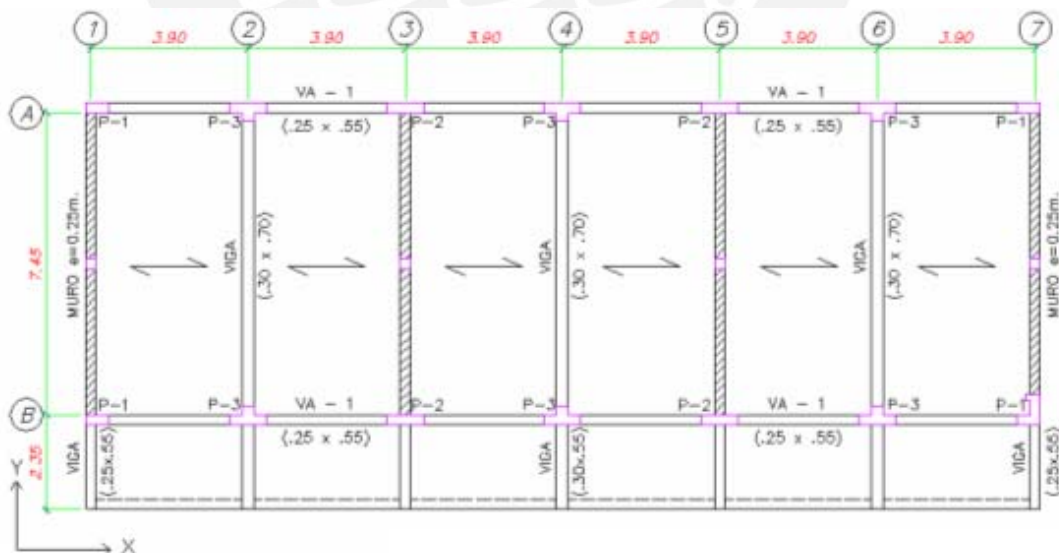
Planta del sistema estructural del colegio 780 nuevo
